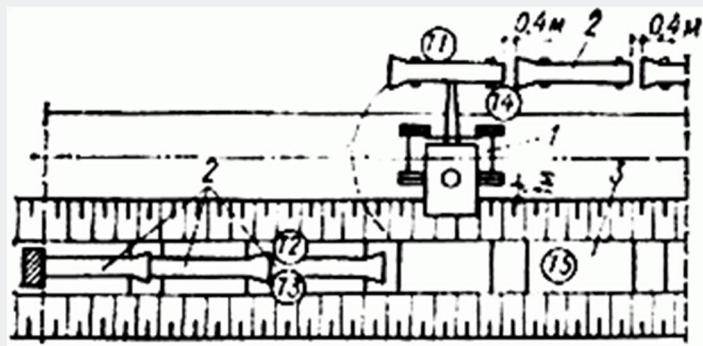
Общая схема организации работ (Т1-Т5 - места монтажников трубопроводов)
